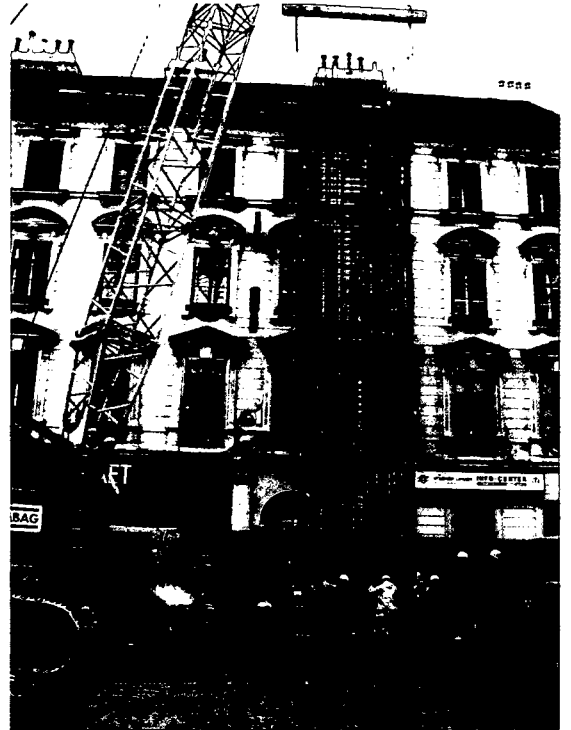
Einbau des unteren Bewehrungskorbes in den Schlitz. Der Abstand zu den bestehenden Gebäuden beträgt nur etwa 2,5 m.
